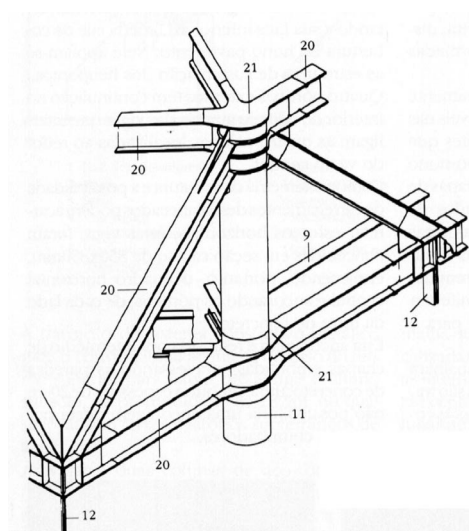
Detalhe de ligação da estrutura de coroamento
